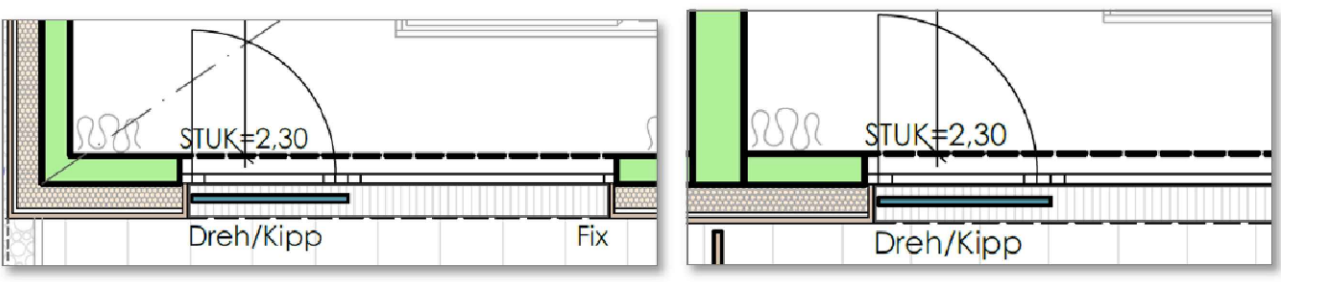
Darstellung vorgesetzte Glasscheiben (Grundriss)
